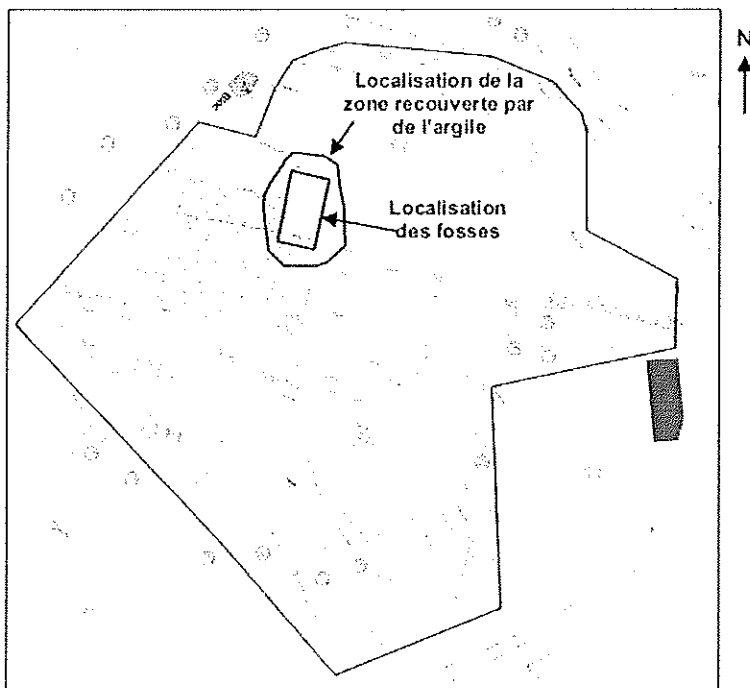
Plan de localisation des anciennes fosses à déchets (extrait du plan de recollement du site sans échelle)
